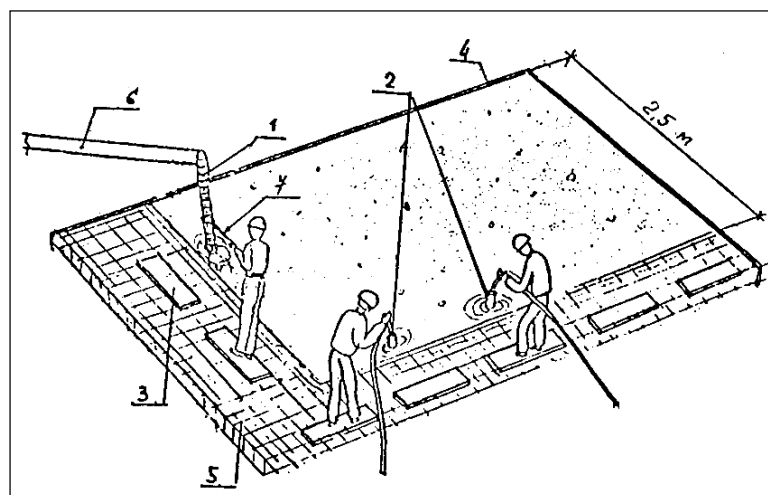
Схема организации рабочего места при бетонировании монолитной плиты
